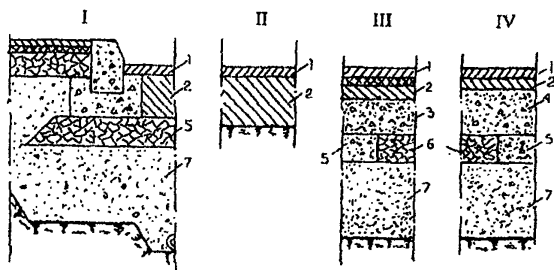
Принципиальные схемы дорожной конструкции с асфальтобетонным покрытием
